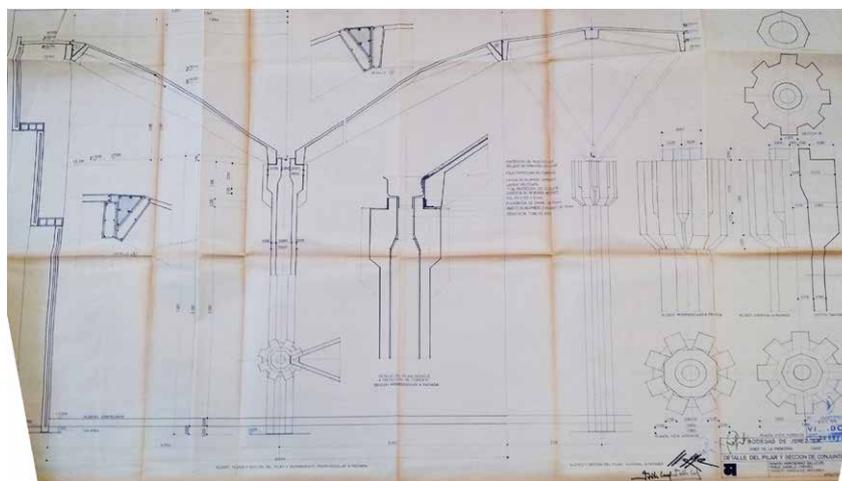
Planimetría original. Detalles de pilar y anclajes de pétalos de hormigón prefabricados. Fuente: Archivo del Colegio de Arquitectos de Cádiz.
